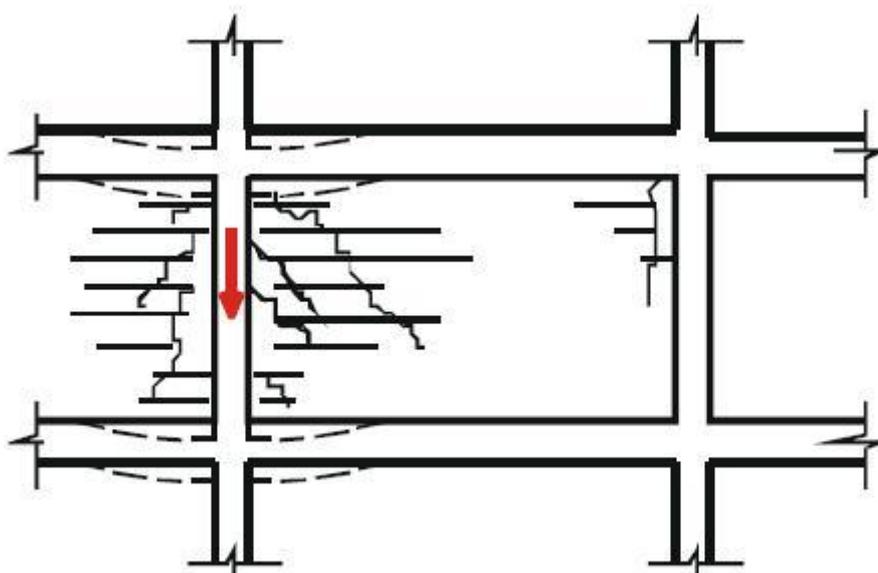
Fissuras causadas por recalques diferenciados das fundações
